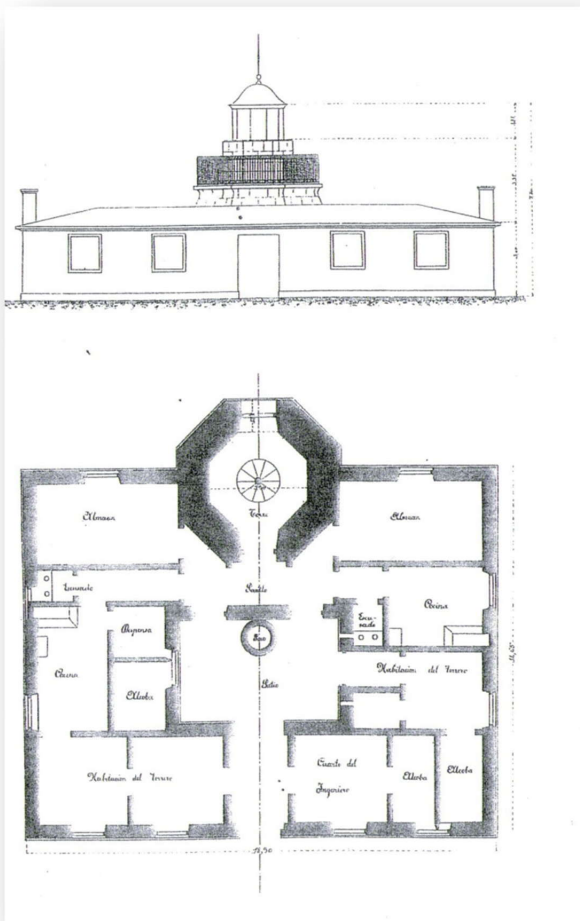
Alzado principal y planta primer faro. Alejandro de Olavarría. 1854. Fuente Faros de Galicia. Fundación Caixagalicia.
